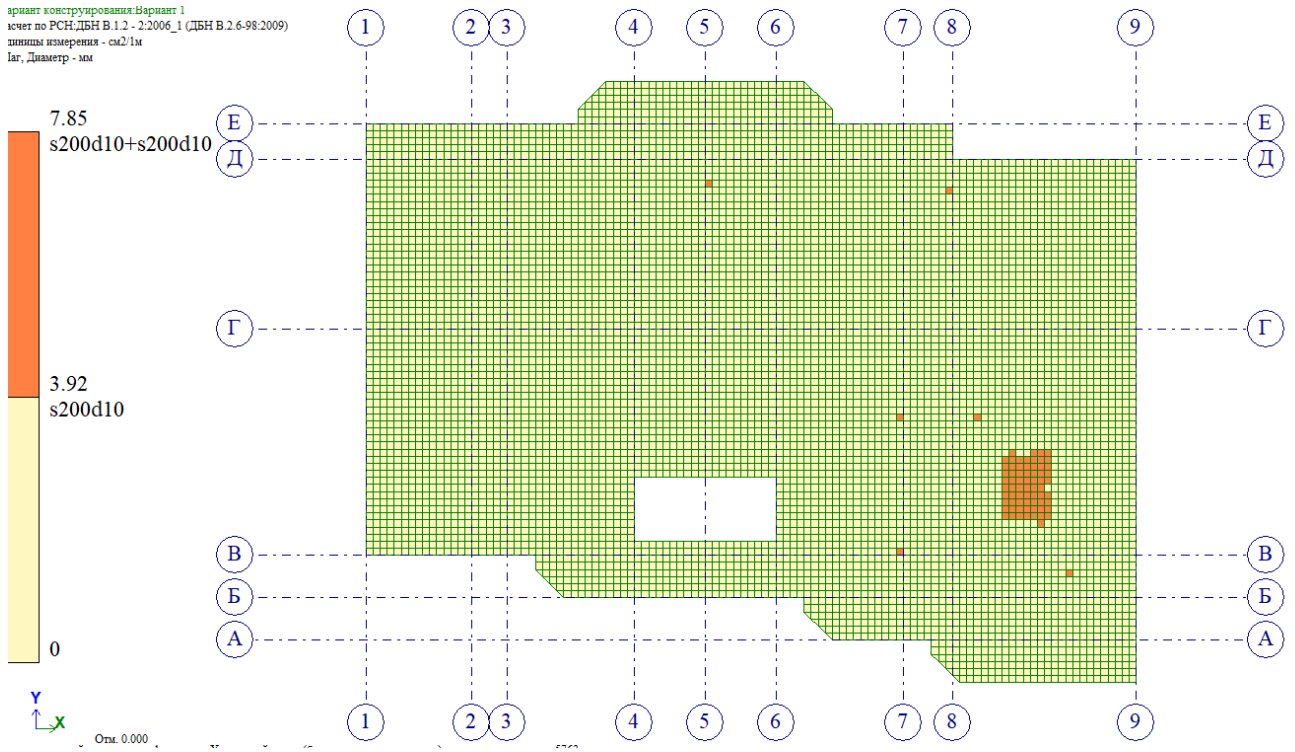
Армування плити перекриття по нижній грані вздовж осі X
